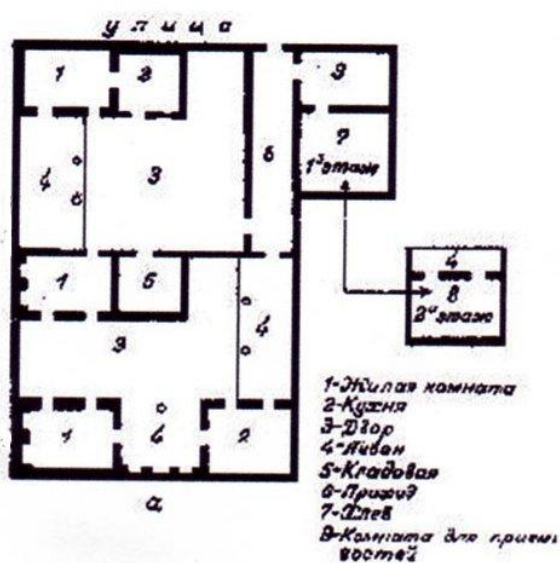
Типичное планировочное решение самаркандского народного жилого дома
